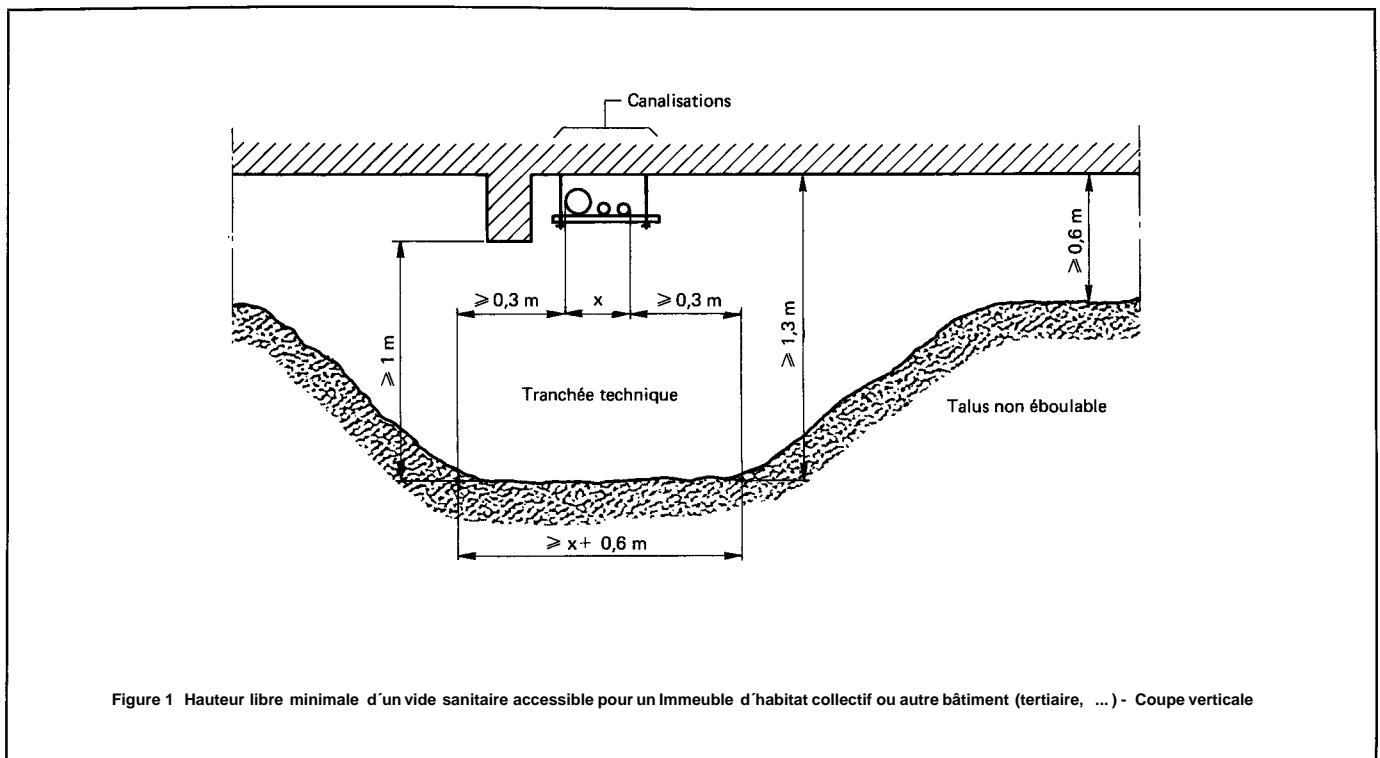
Hauteur libre minimale d'un vide sanitaire accessible pour un Immeuble d'habitat collectif ou autre bâtiment (tertiaire, ...) - Coupe verticale
